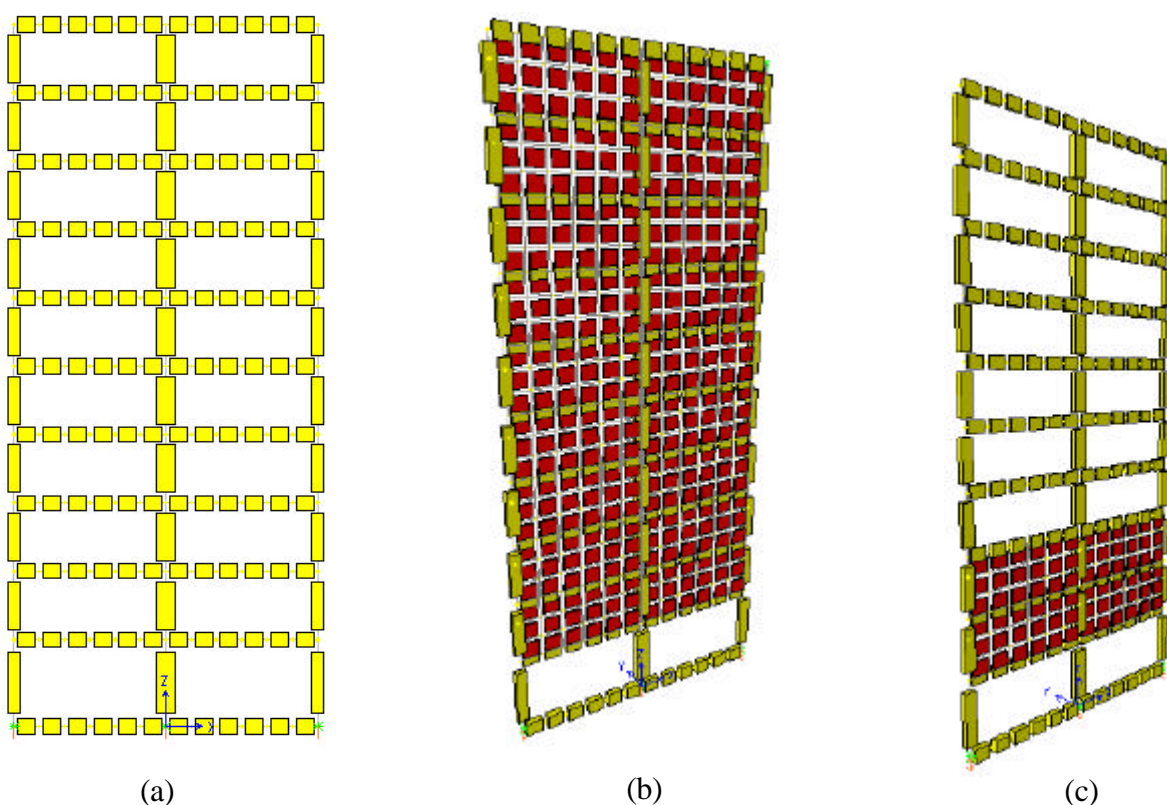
Modelo do pórtico adotado, (a) sem parede, (b) com parede e (c) com parede somente em 2 pavimentos.
